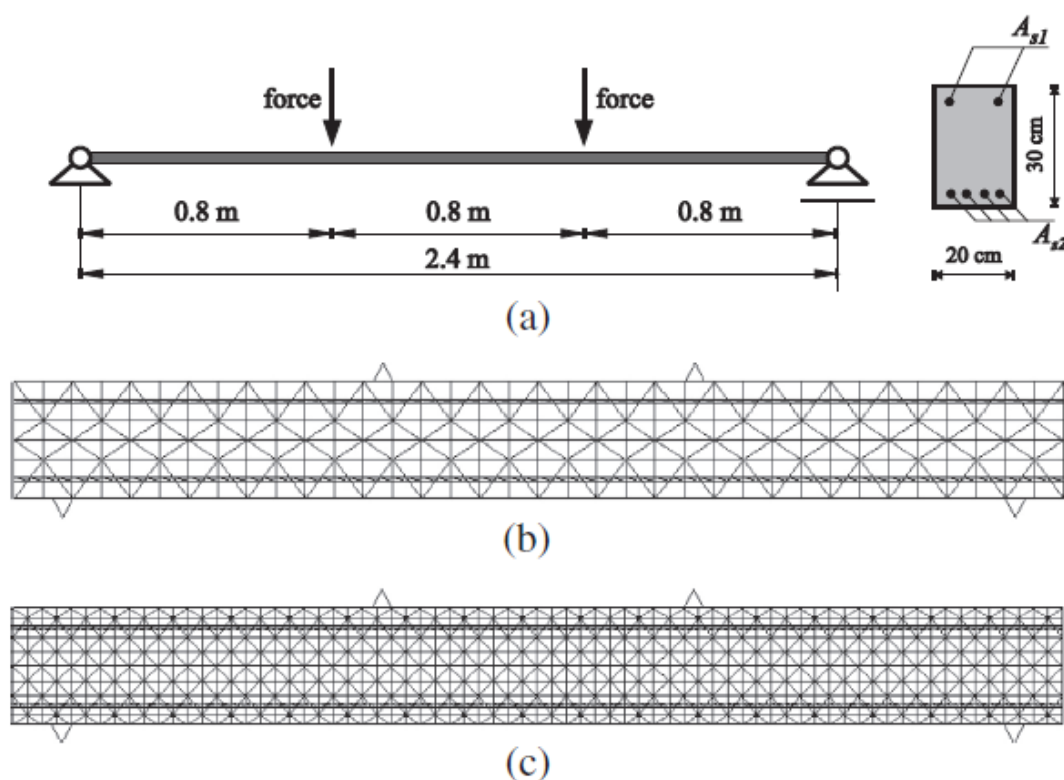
Viga de concreto armada: (a) geometria (b) malha “grosseira” (c) malha “refinada” (Zivaljic *et al.*, 2014)
